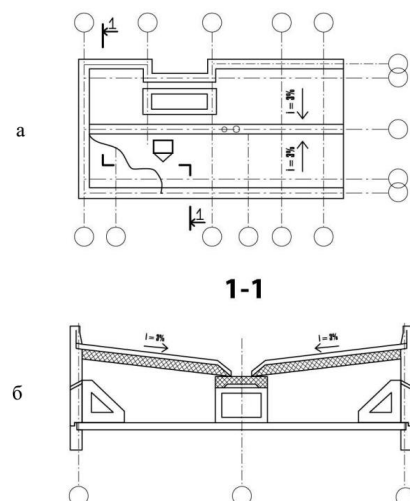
Тепле горище з рулонним покриттям: а – план даху; б – розріз 1-1
